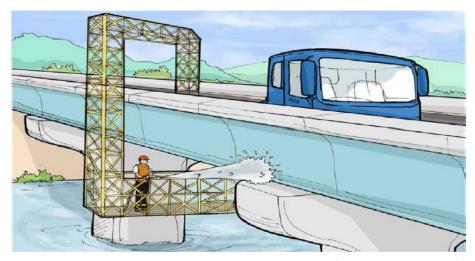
Limpieza de las vigas con la ayuda de un vehículo de inspección.
